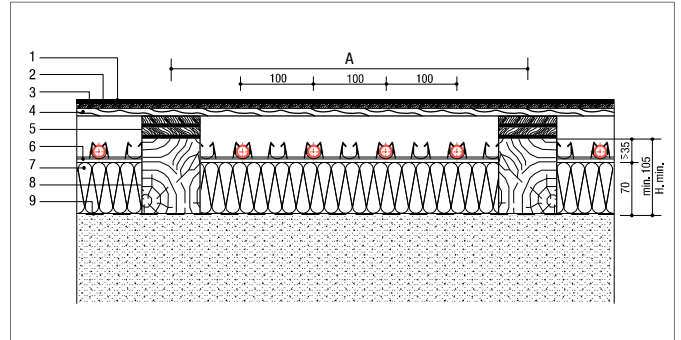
Estructura de la calefacción para pavimento elástico
